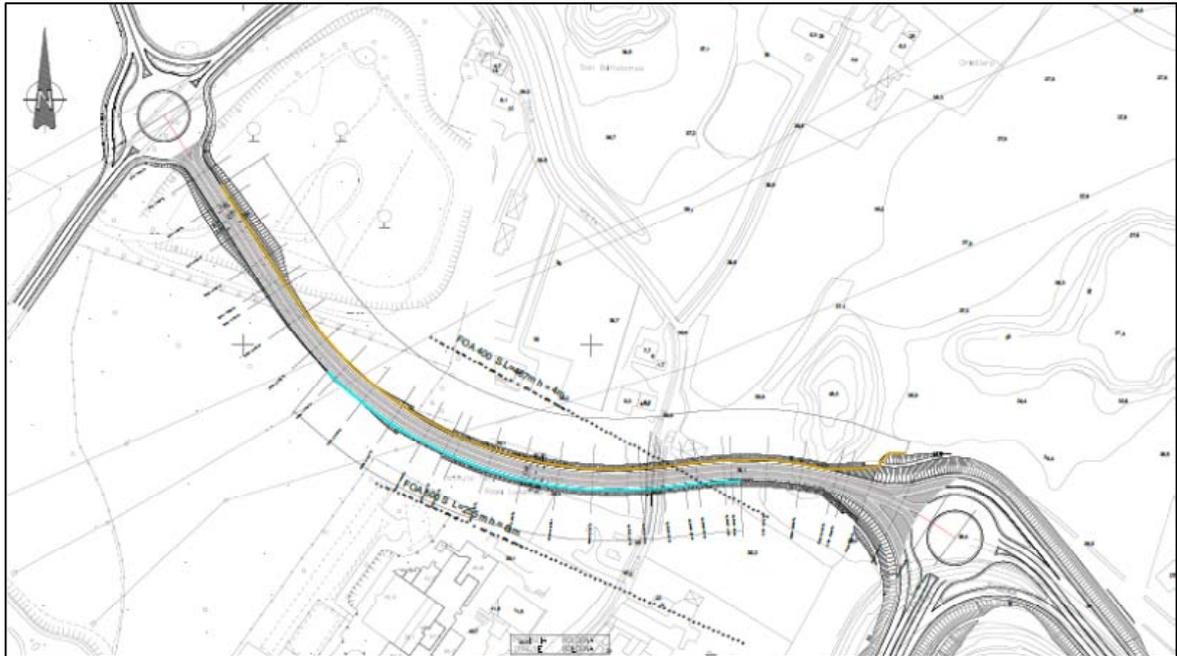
Stralcio planimetrico Collegamento Via Agucchi – Asse Attrezzato
